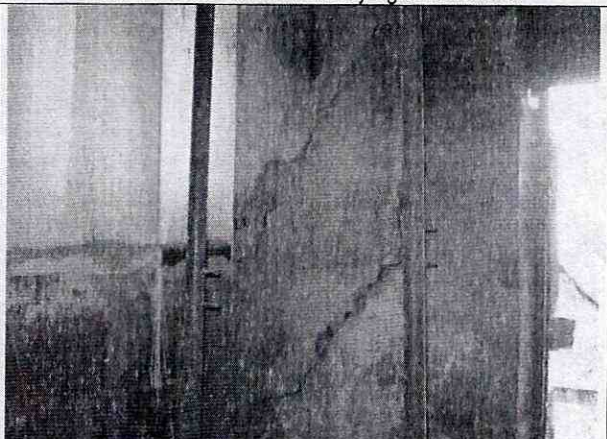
Agrietamientos y fracturas de muros, daño fuerte.
